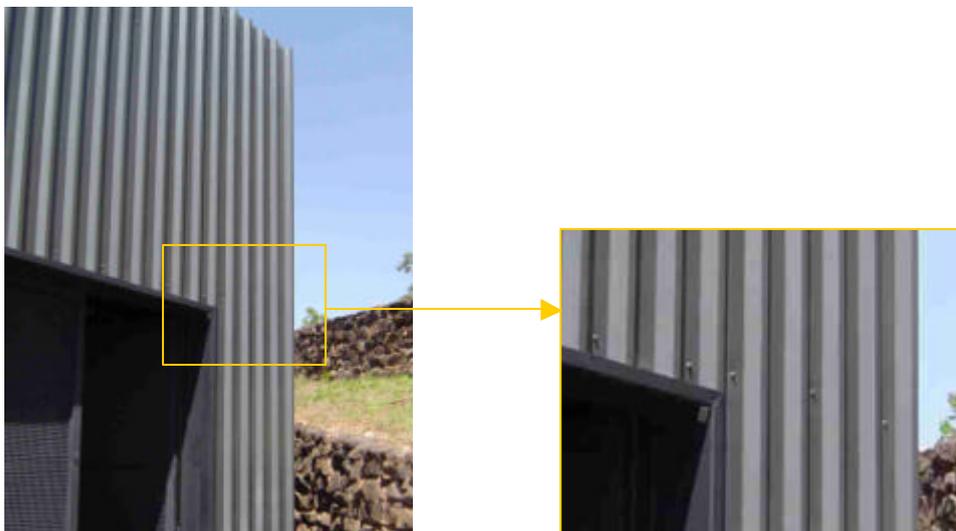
Vista externa da edificação mostrando o revestimento em telha metálica.
